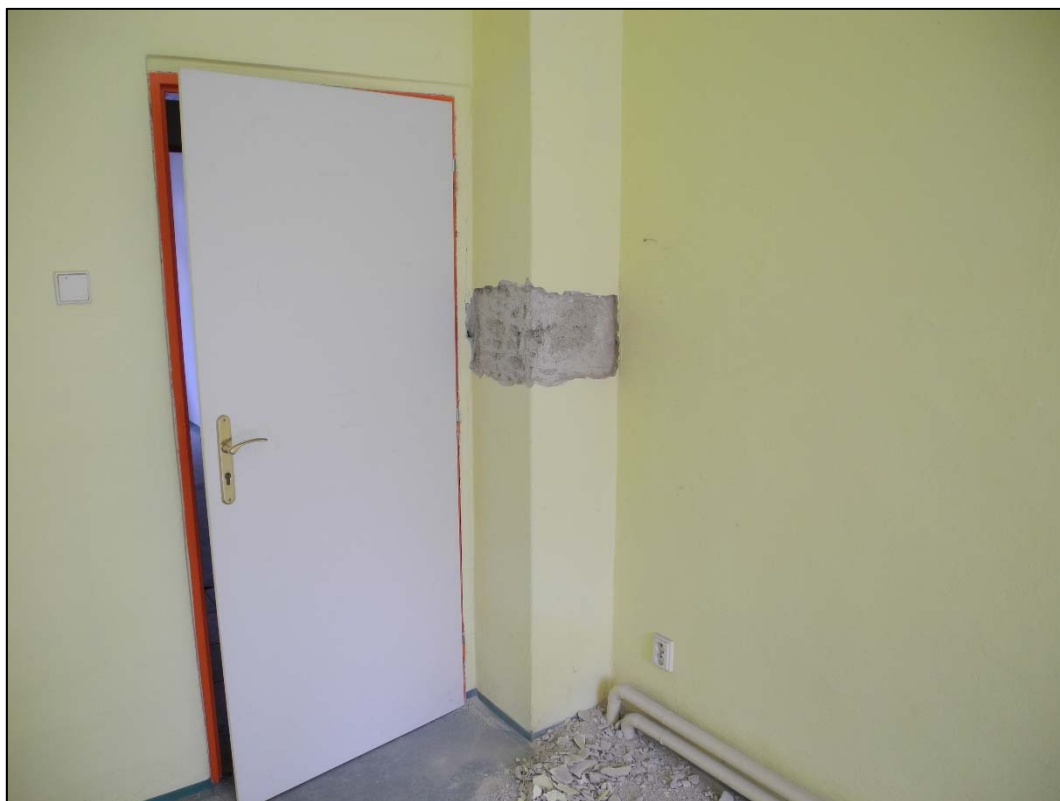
Celkový pohled na sondu B2 – betonový sloup v místnosti 1.26
